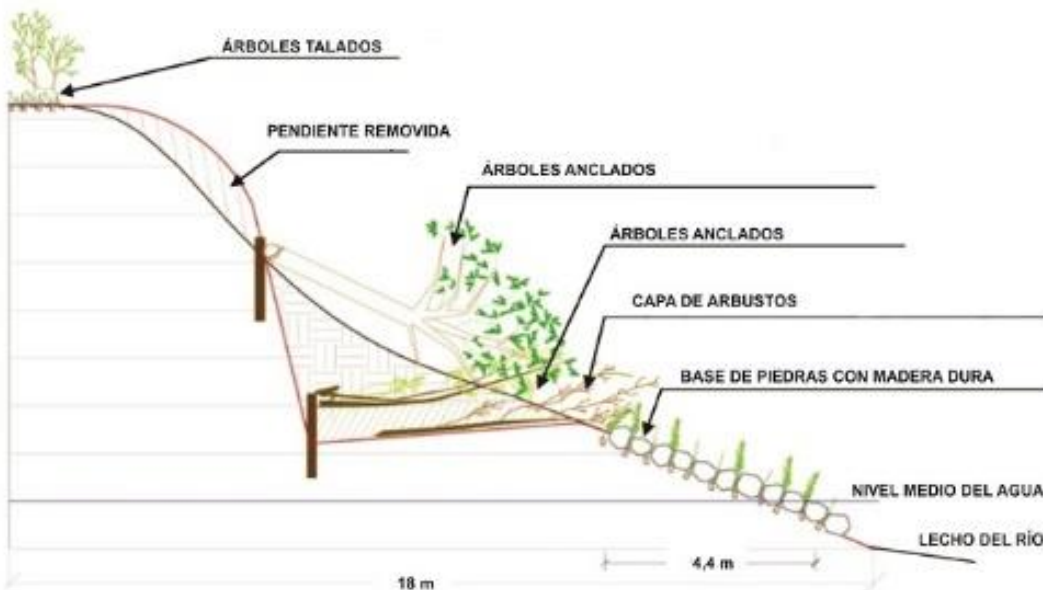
Ejemplos de posibles opciones de bioingeniería e ingeniería tradicional en conjunto. Adaptado de: Rauch et al. (2014).
